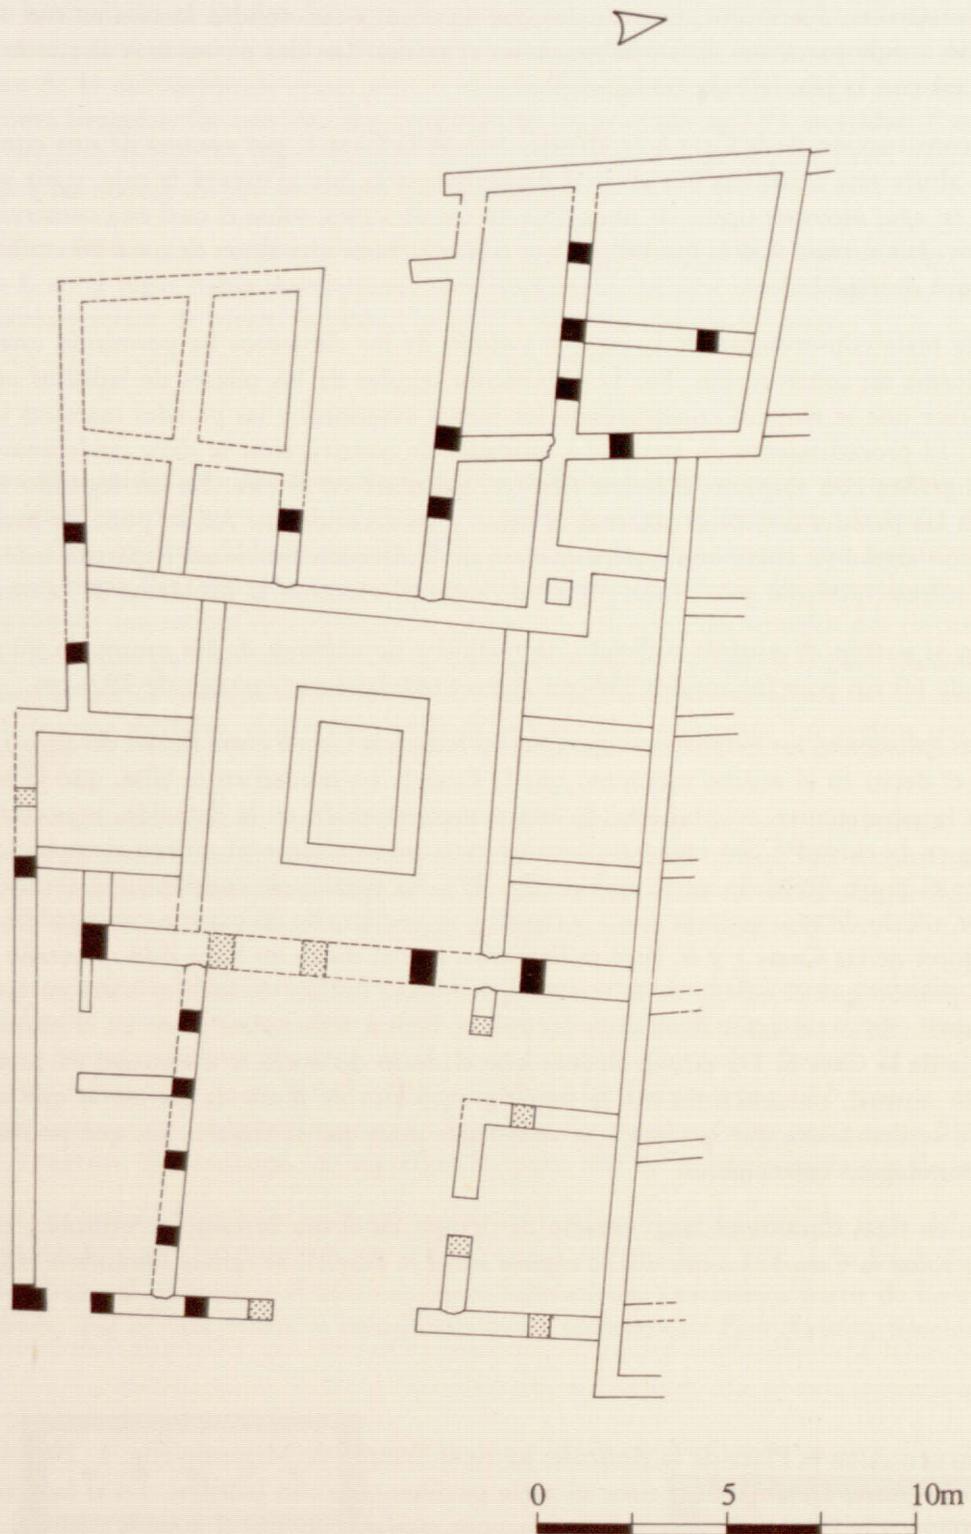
Casa 6, planta piso bajo con disposición de los pilares de ladrillos (reconstrucciones en gris).
